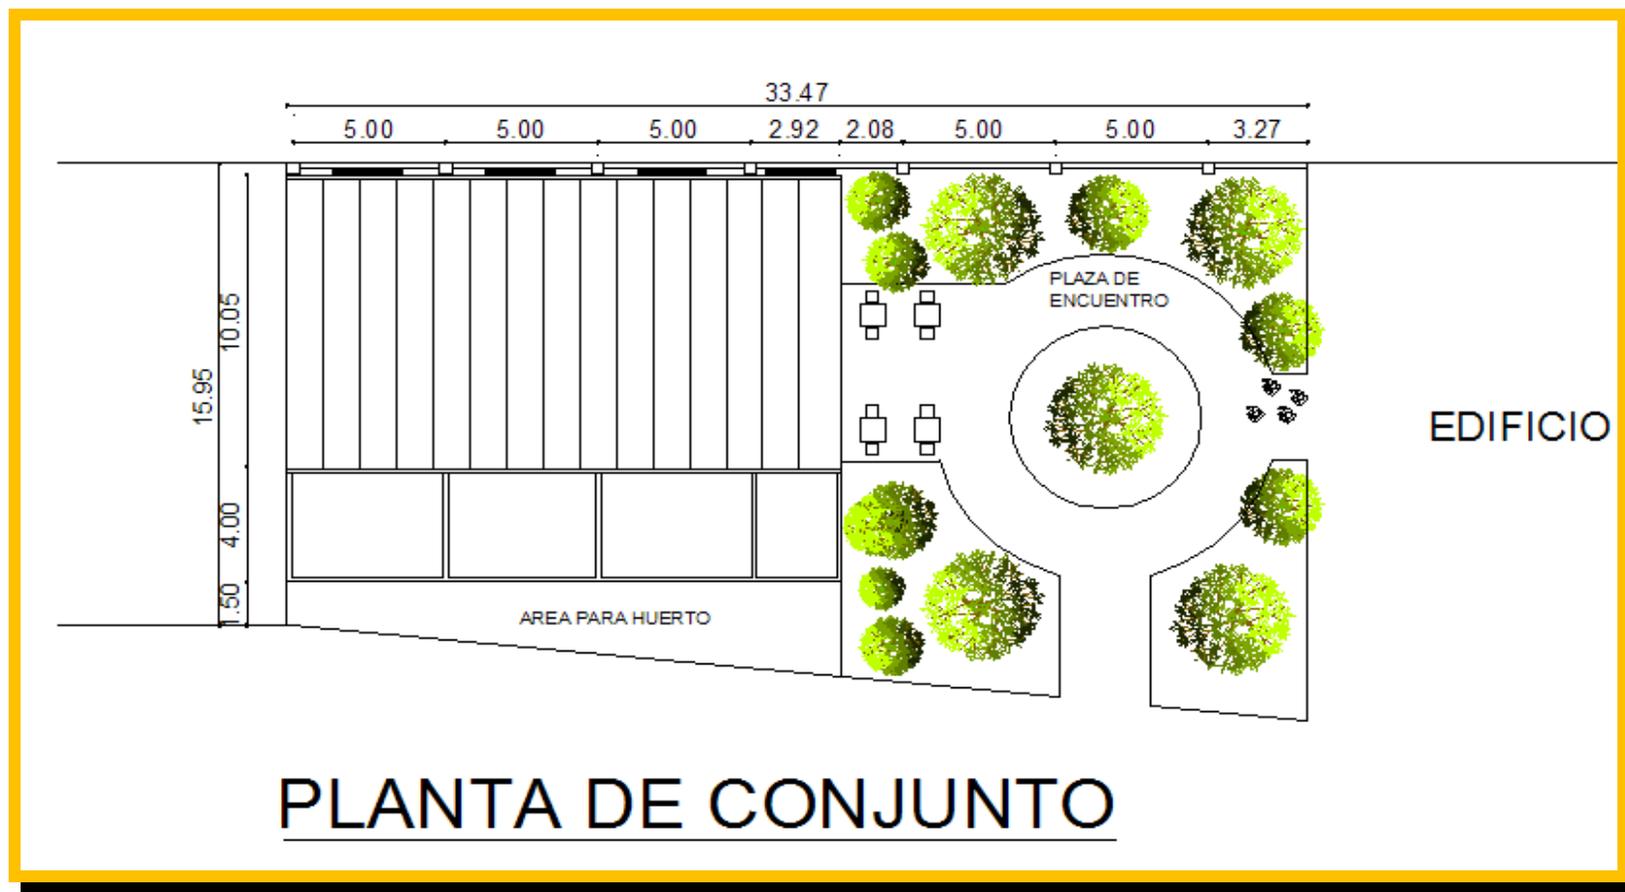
(planta de conjunto-u.h. Emiliano Zapata)
